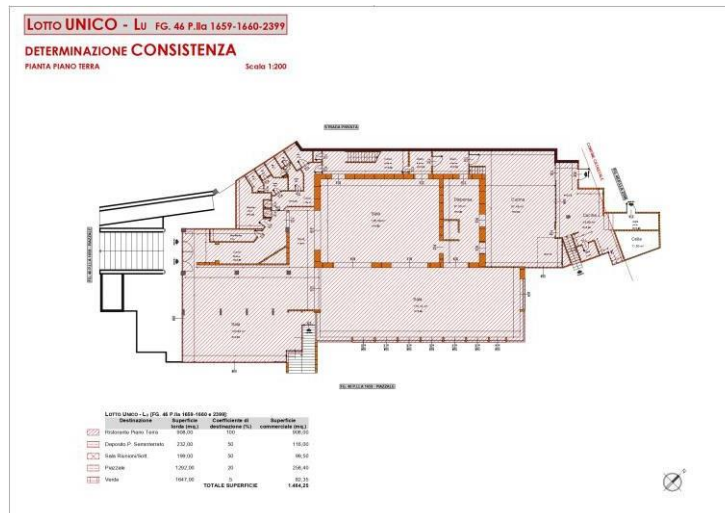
Determinazione consistenza Lotto LU – P. 3. (ALL. 10).
